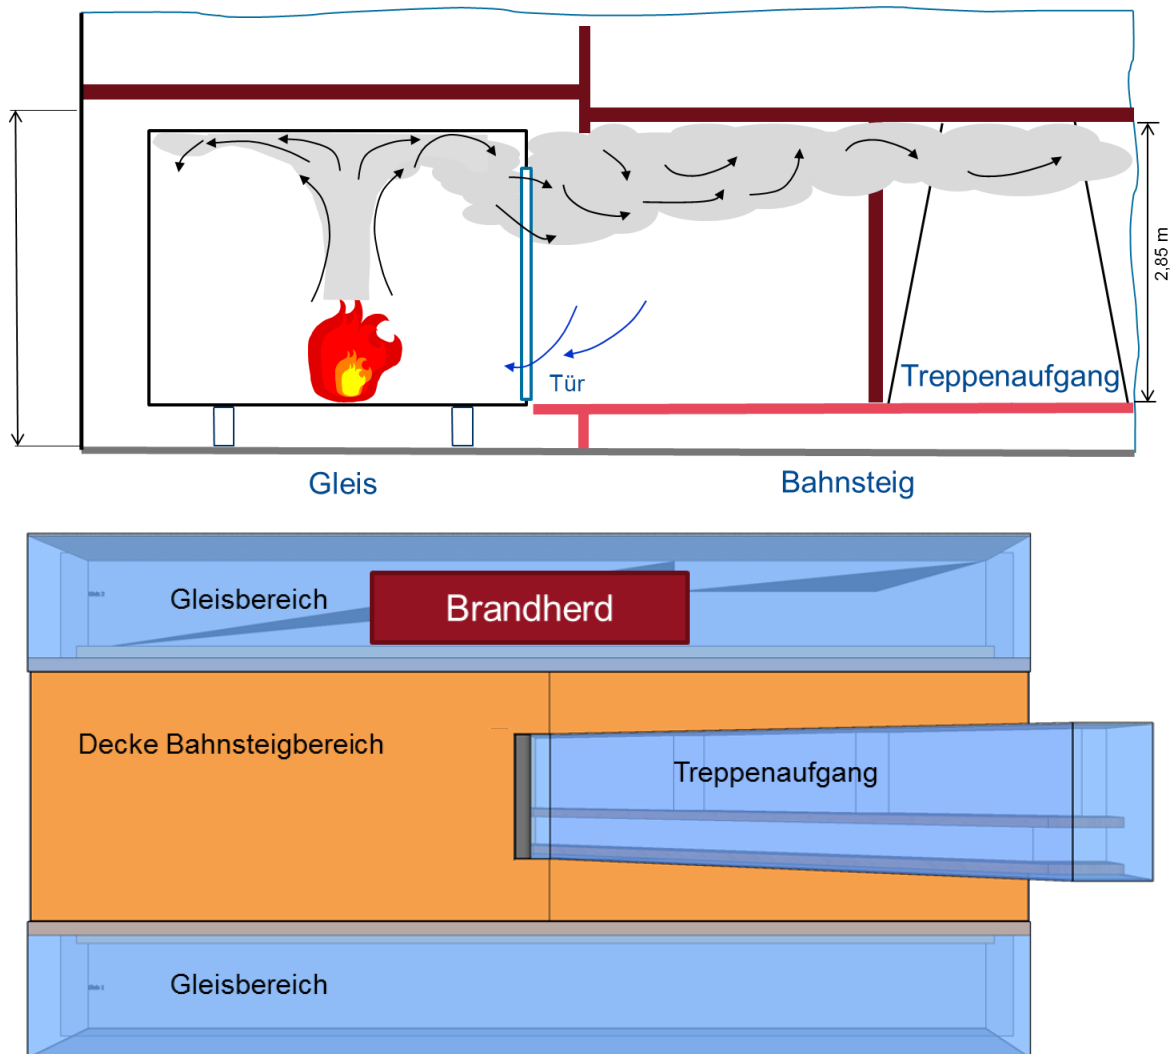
Prinzipskizze des Versuchsaufbaus im Schnitt und Brandposition im Grundriss (unten)
